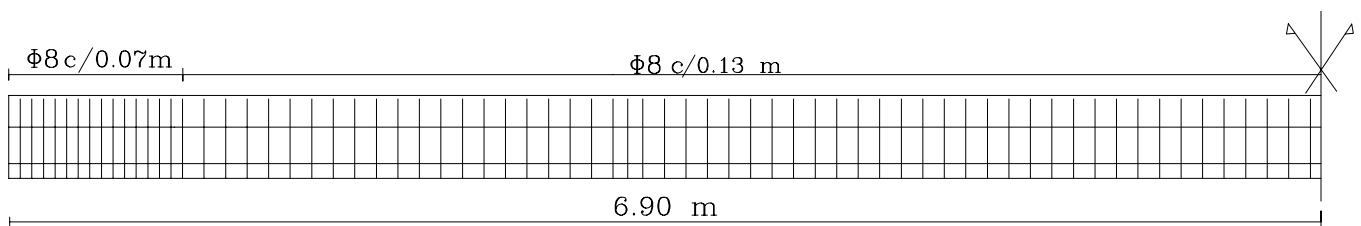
VISTA LONGITUDINAL DE LA VIGA
